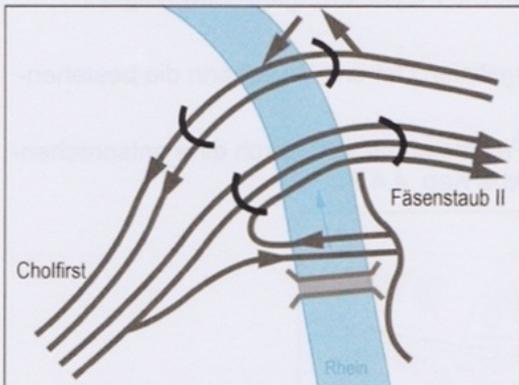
Variante "eng" + 3-streifiger Tunnel Fäsenstaub
